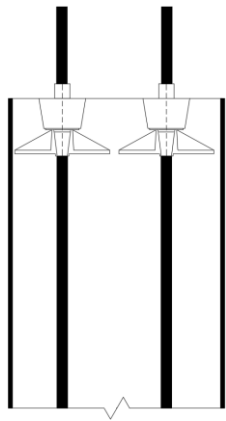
Armaduras do pilar P6 - dimensões em mm (Fonte: Autor)
